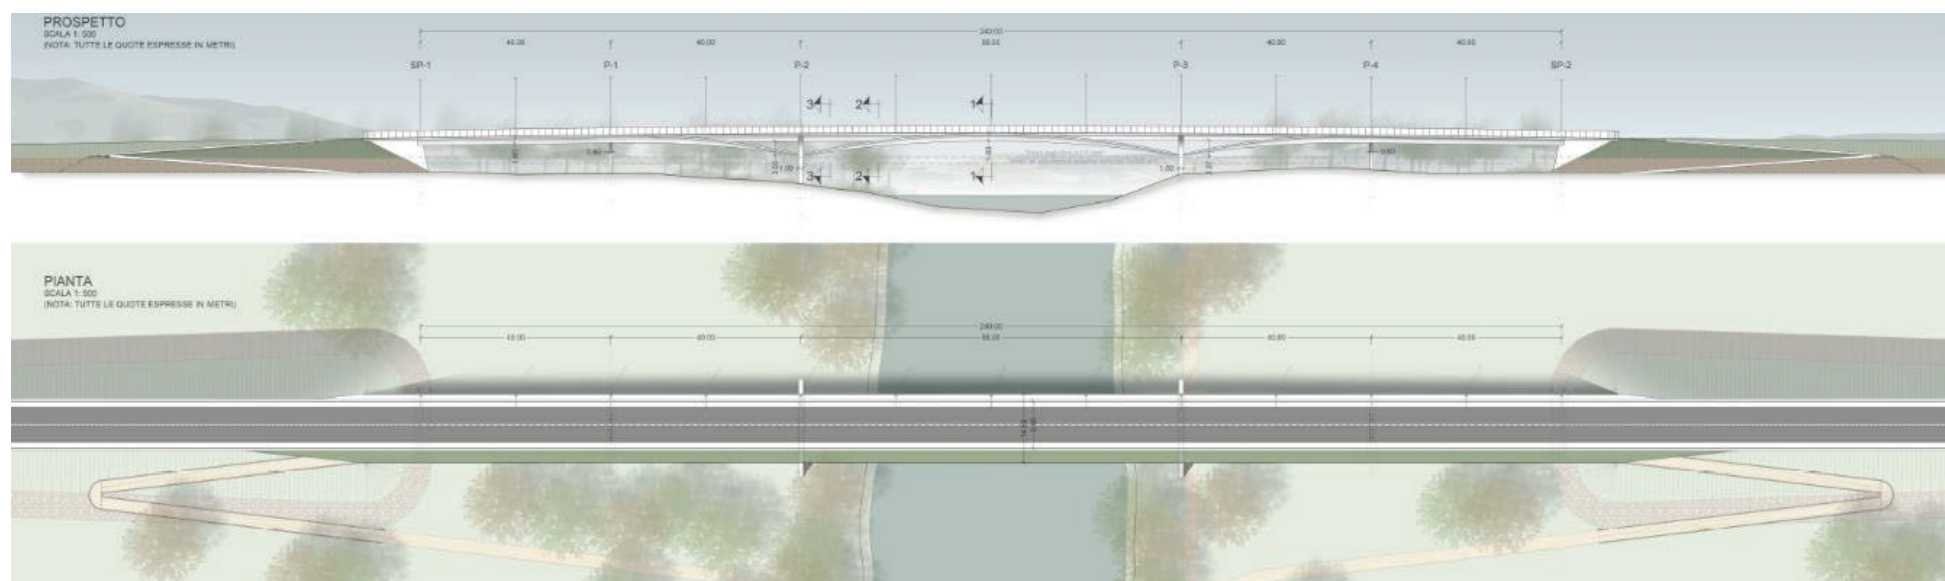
Prospetto e pianta della soluzione strutturale per l'attraversamento del fiume
